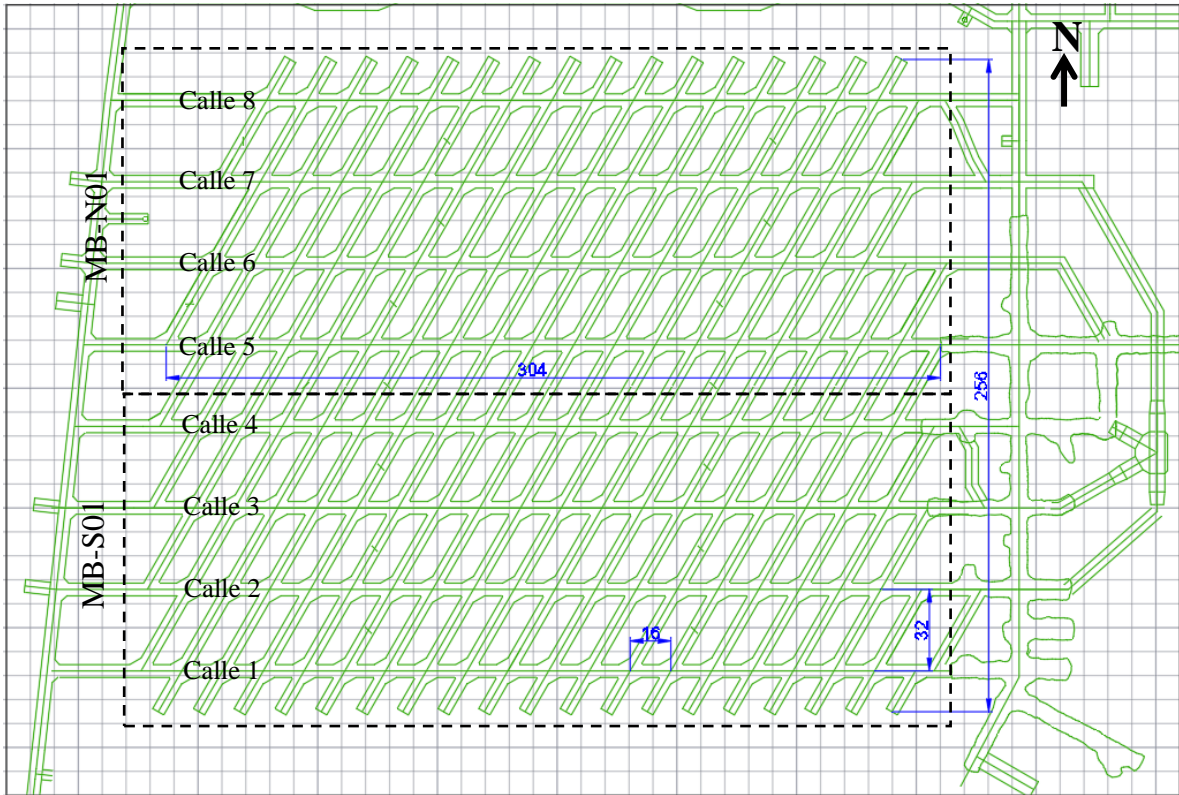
Vista en planta de subnivel de producción MB N01 y S01
